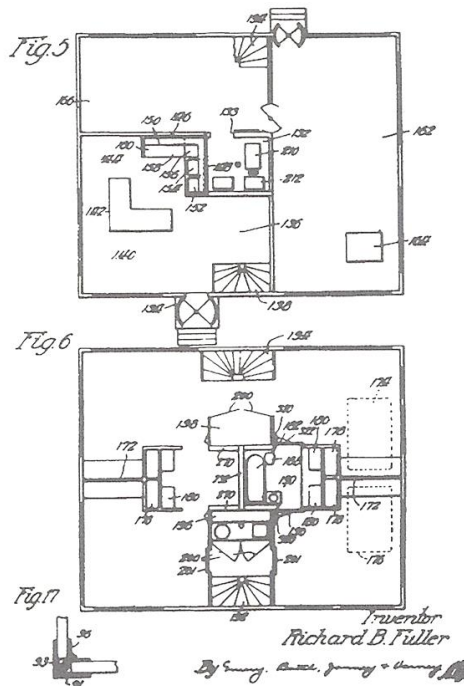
Plantas patente 4D House. Hincley, empleado del estudio Russell Walcott, 1928
